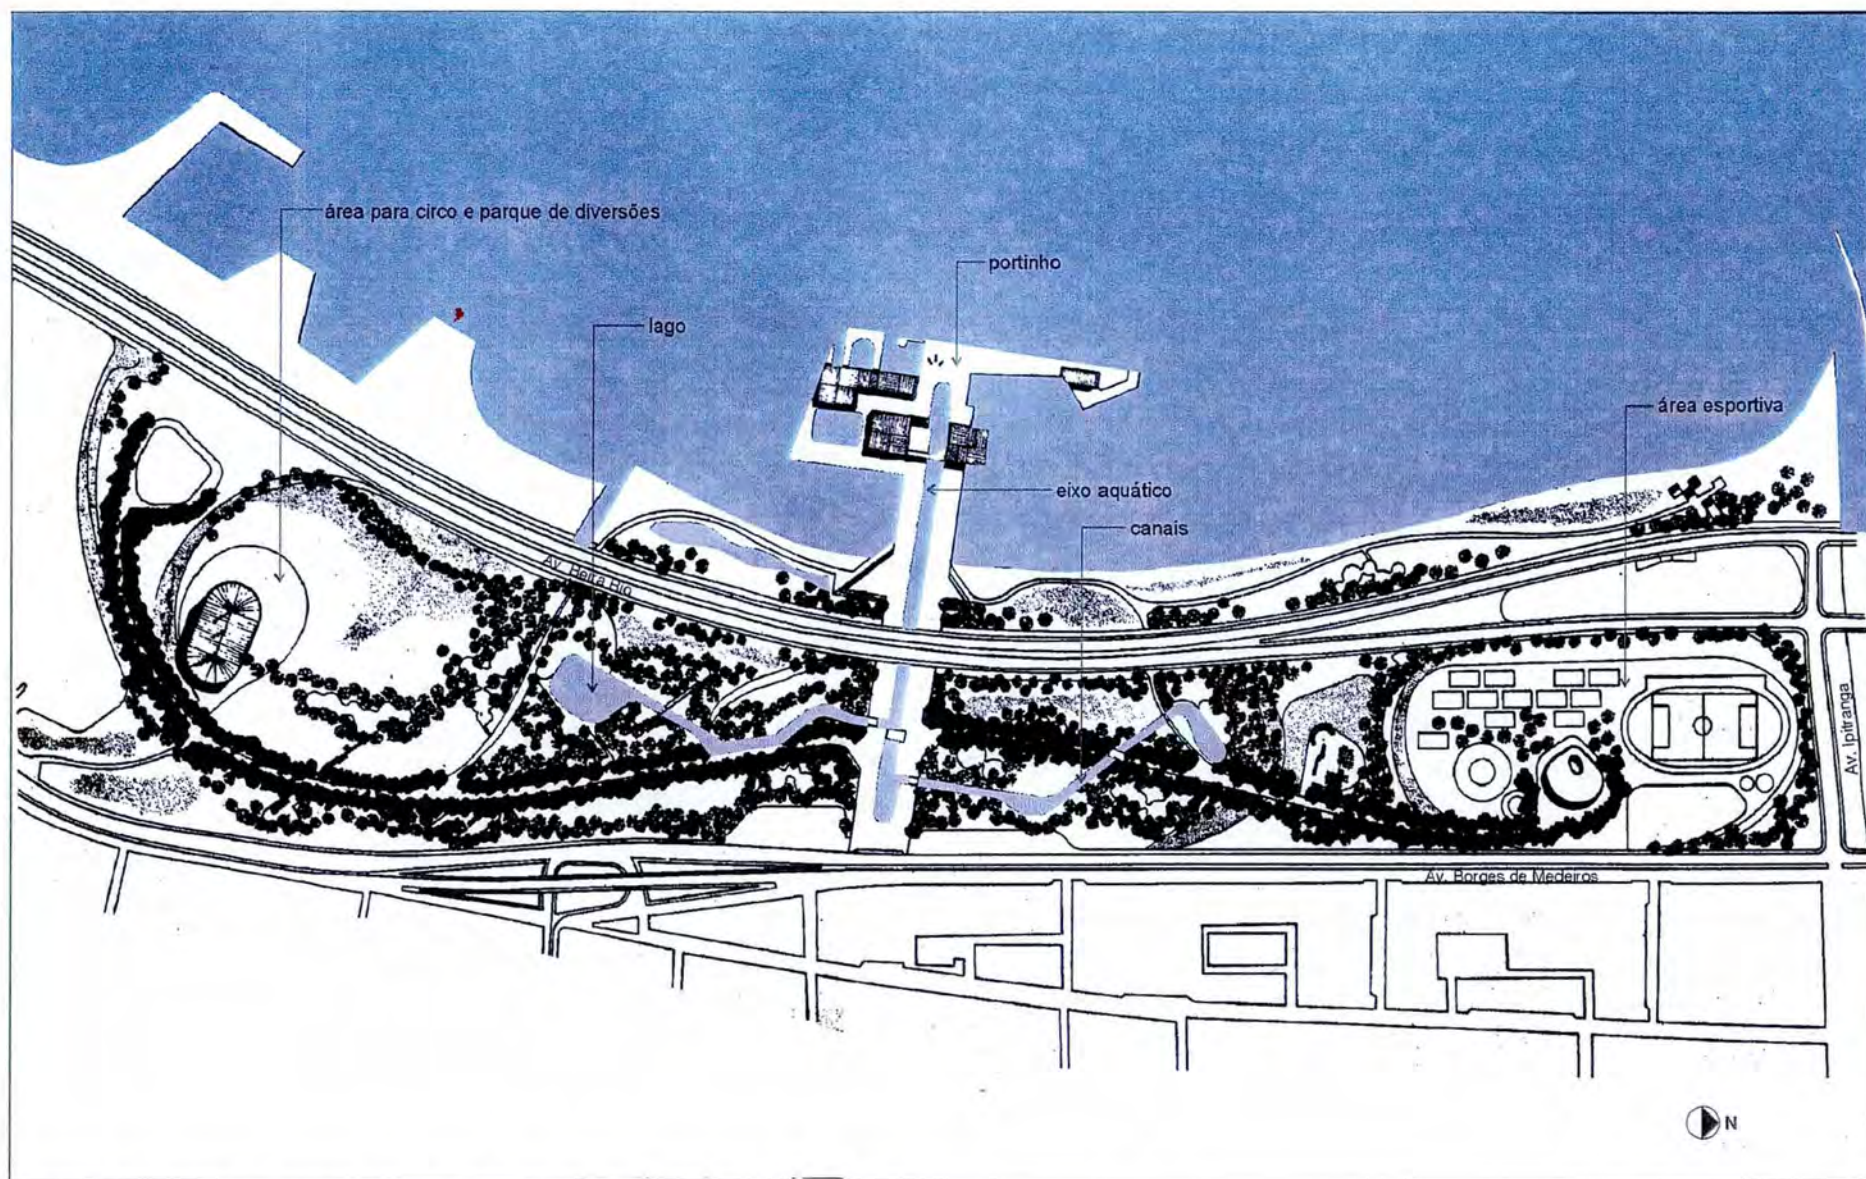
Concurso Parque Marinha do Brasil, primeiro colocado - Planta Geral
